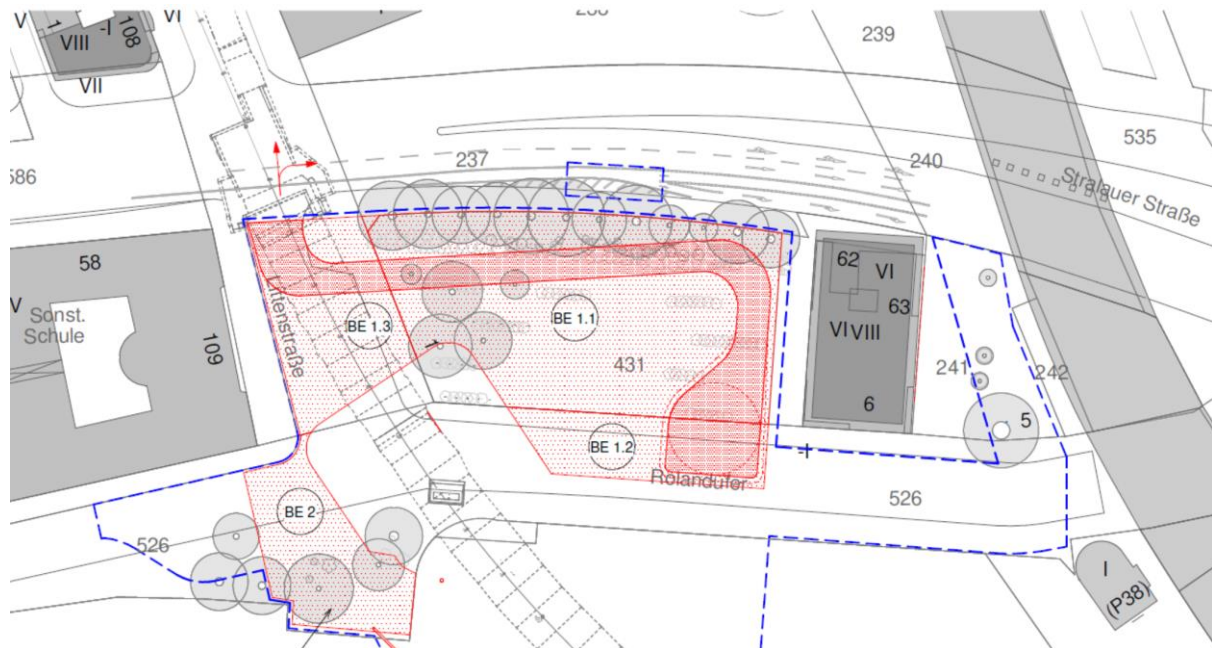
Lageplan zentrale BE-Fläche Rolandufer
